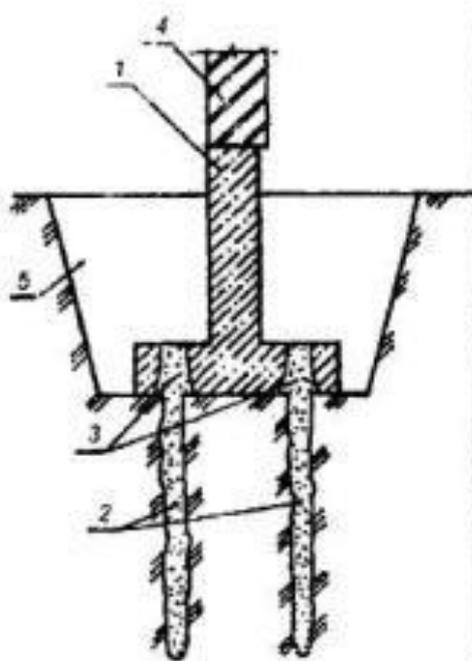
1 - усиливаемый ленточный фундамент; 2 - буроинъекционные (корневидные) сваи, устраиваемые через плитную часть усиливаемого фундамента; 3 - конусные отверстия в плитной части фундамента; 4 - кирпичная стена; 5 - пазух, заполняемый фунтом после устройства стыка свай с плитной частью фундамента.
